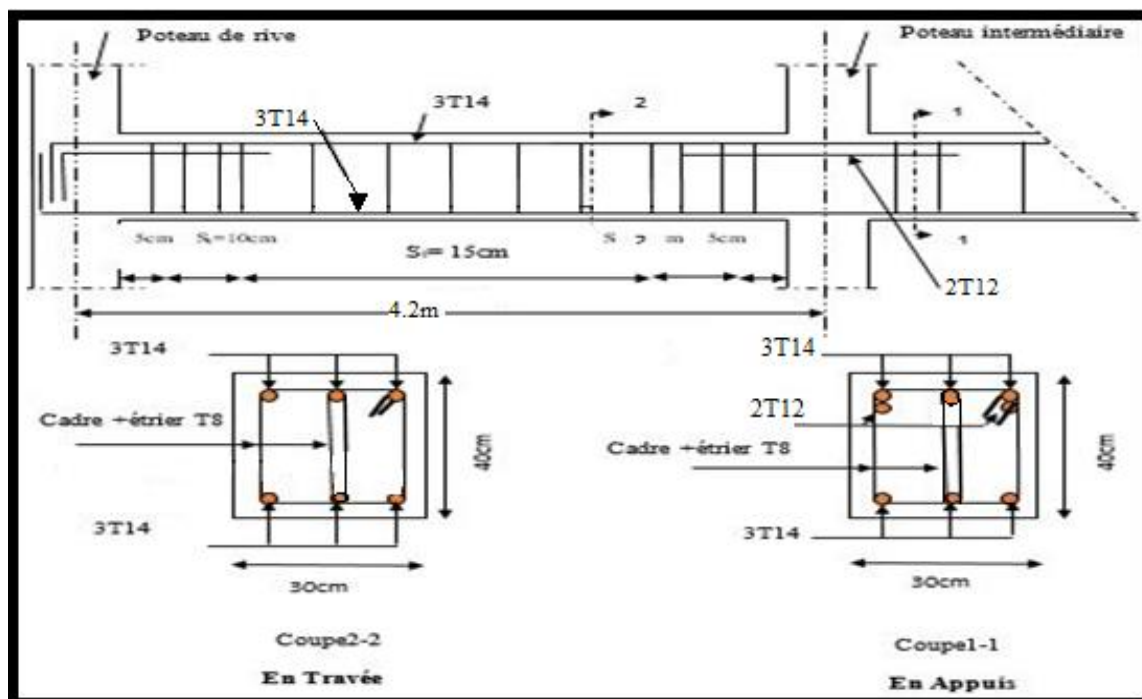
schéma de ferrailage des poutres principales associées au voile.
